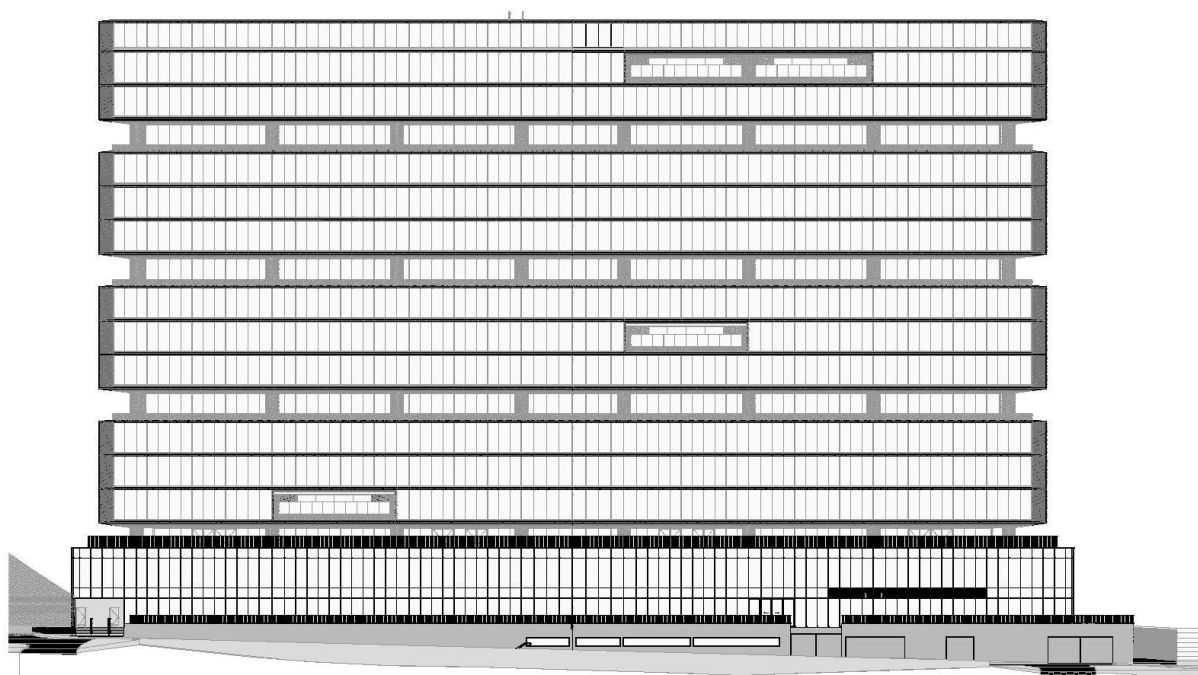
Fachada D / Fundo (lateral Leste do lote) do Edifício Lótus Tower.
